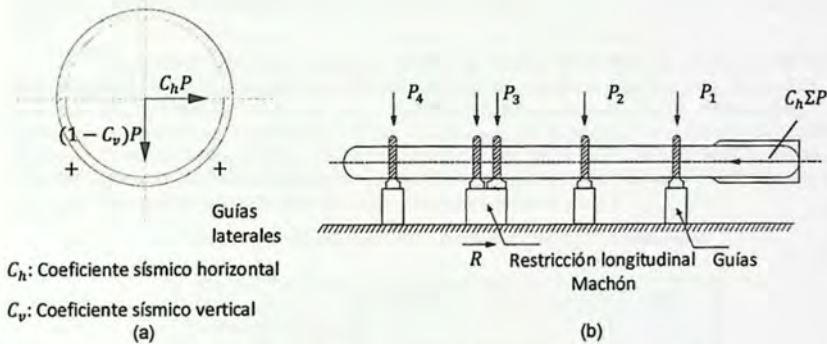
a) Apoyo lateral de la cañería b) Elevación de la cañería.
